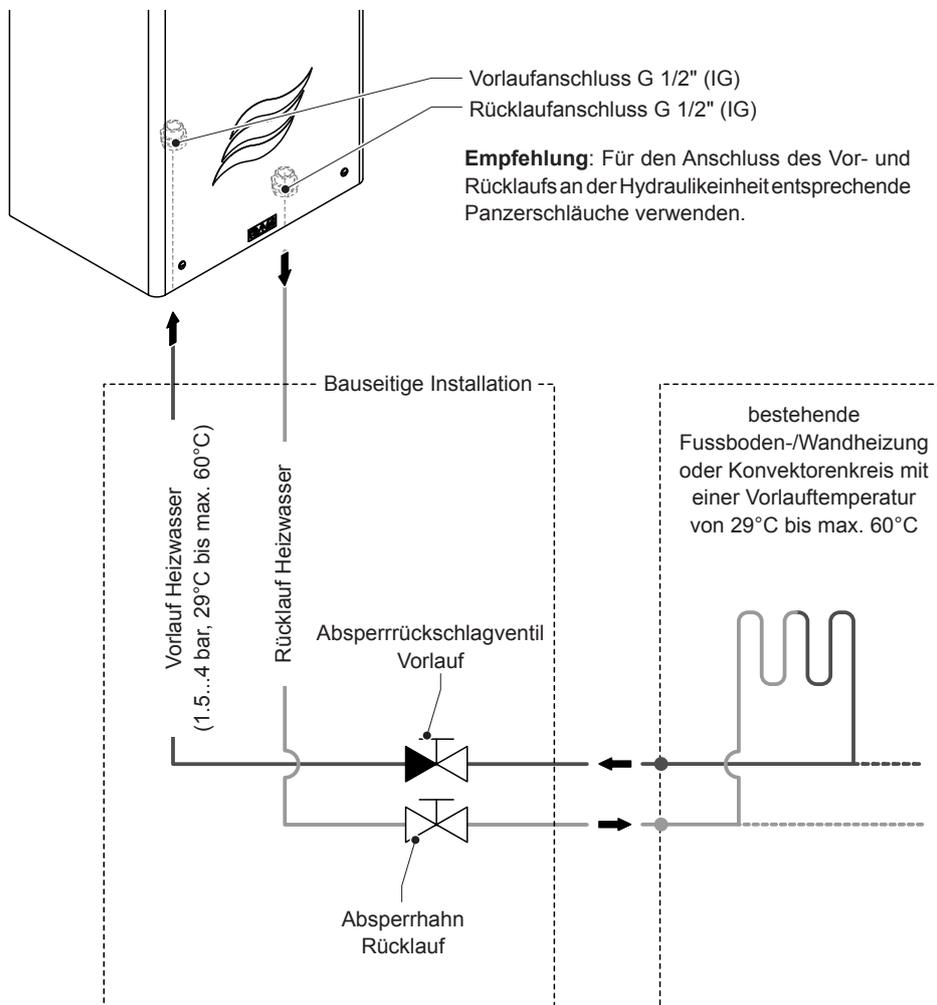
Heizwasserinstallation für Variante MD-FB-H
